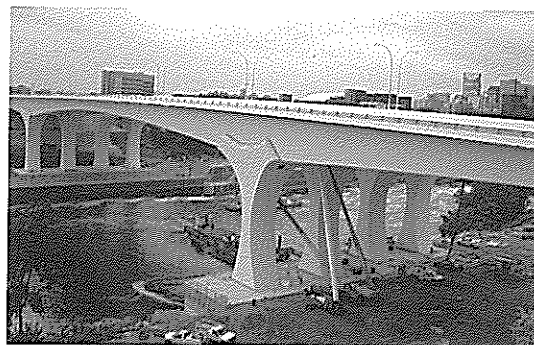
新しいI-35W橋 (St. Anthony Falls Bridge)
